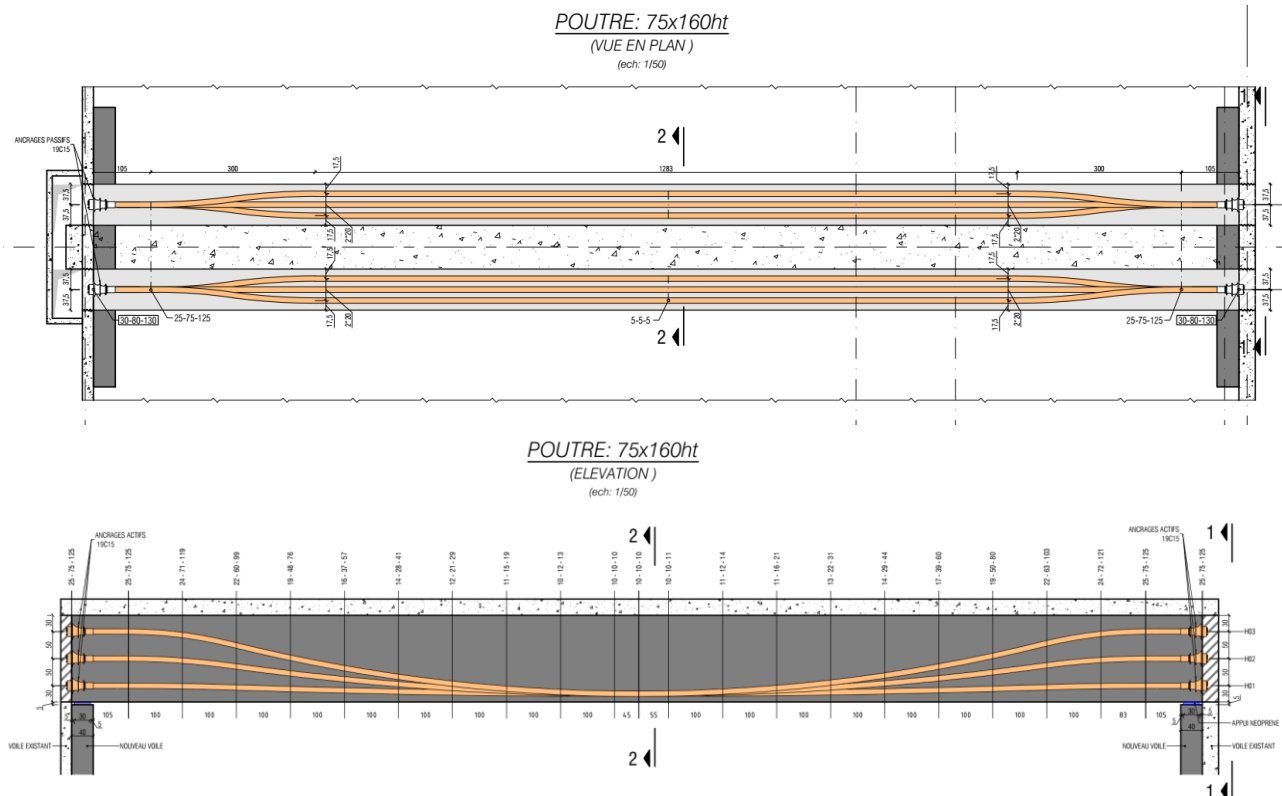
Plano y sección longitudinal de las vigas pretensadas.
